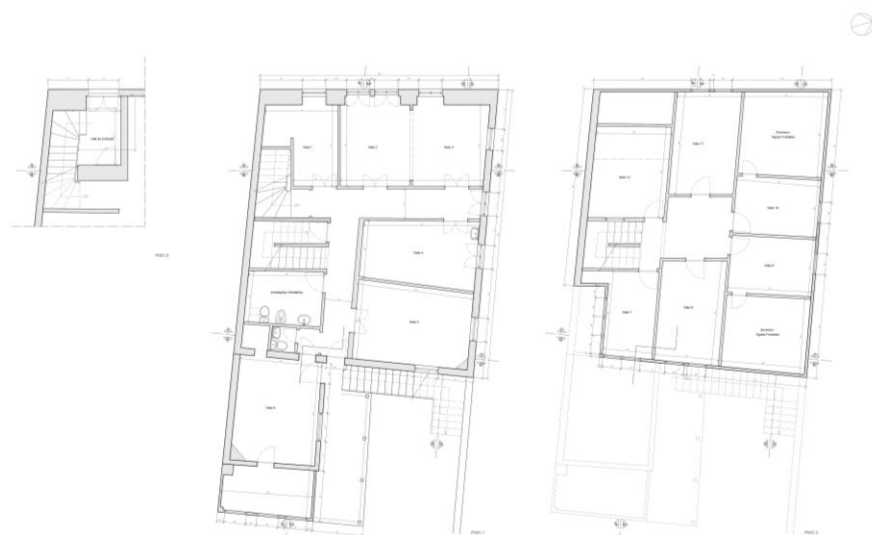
Planta de levantamento - esc. 1/50; Fonte: Ana Ferreira
